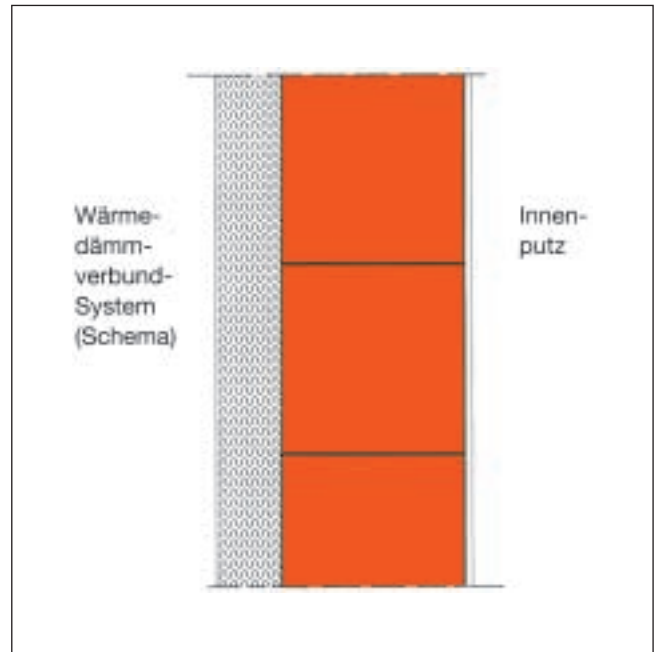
Schnitt durch einschaliges PlanZiegel-Mauerwerk und Wärmedämmverbundsystem auf der Außenseite
